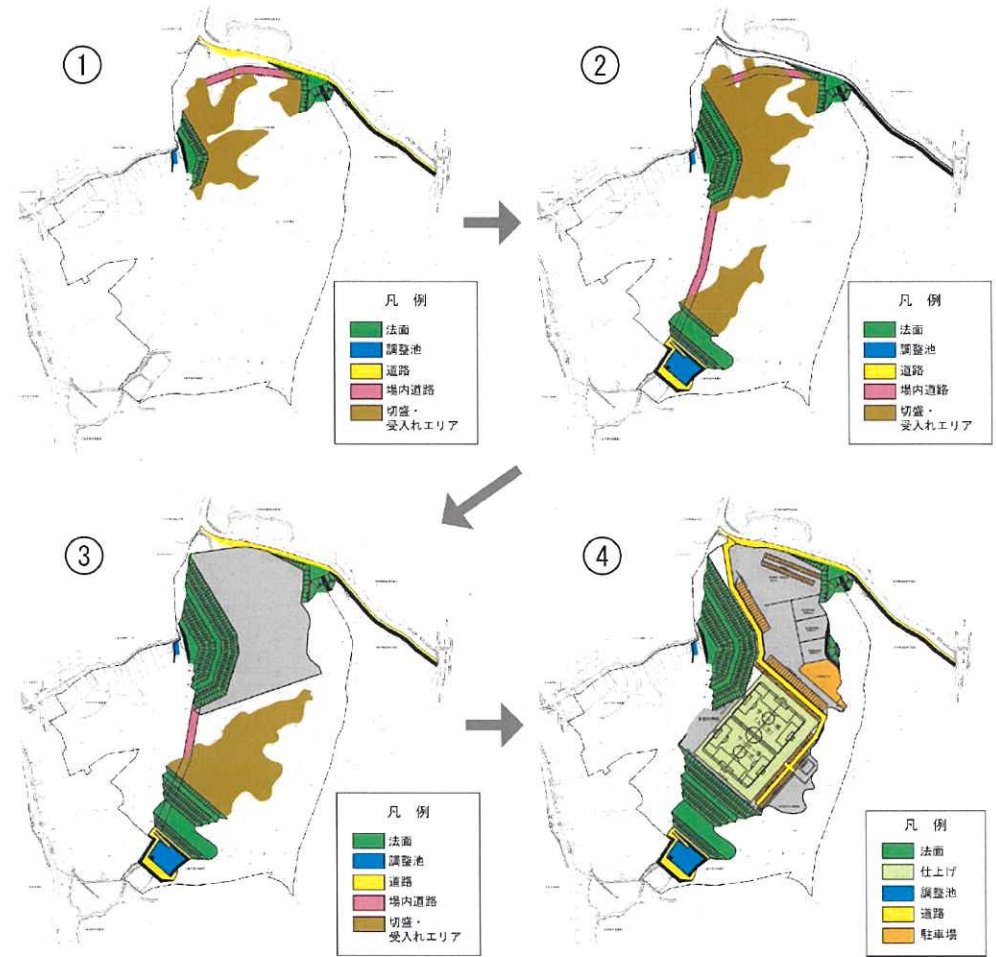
段階施工による退避路の確保・施工ステップ図
